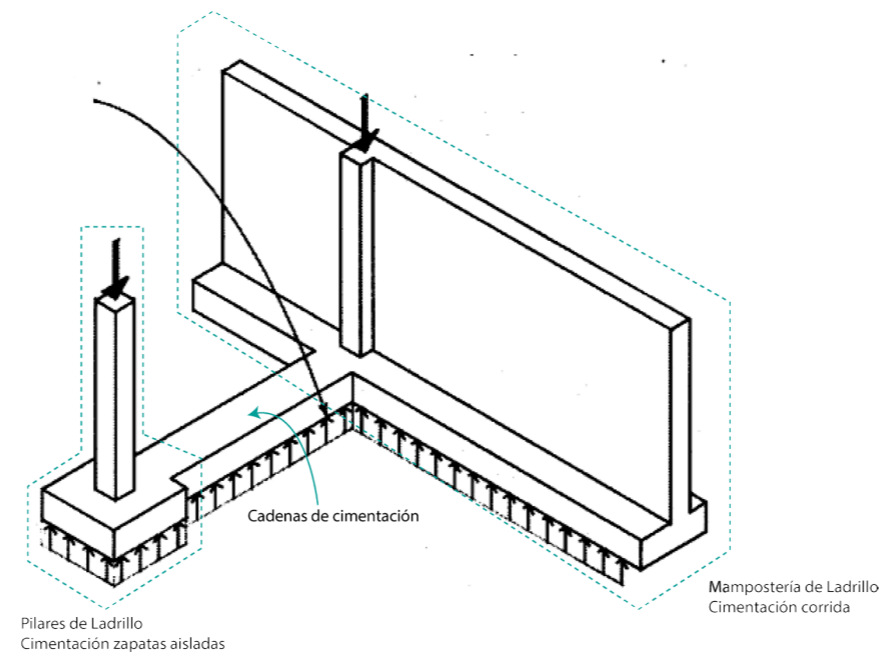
Sistema estructural para el proyecto . Adaptado de (Arquitectura, 2014)
